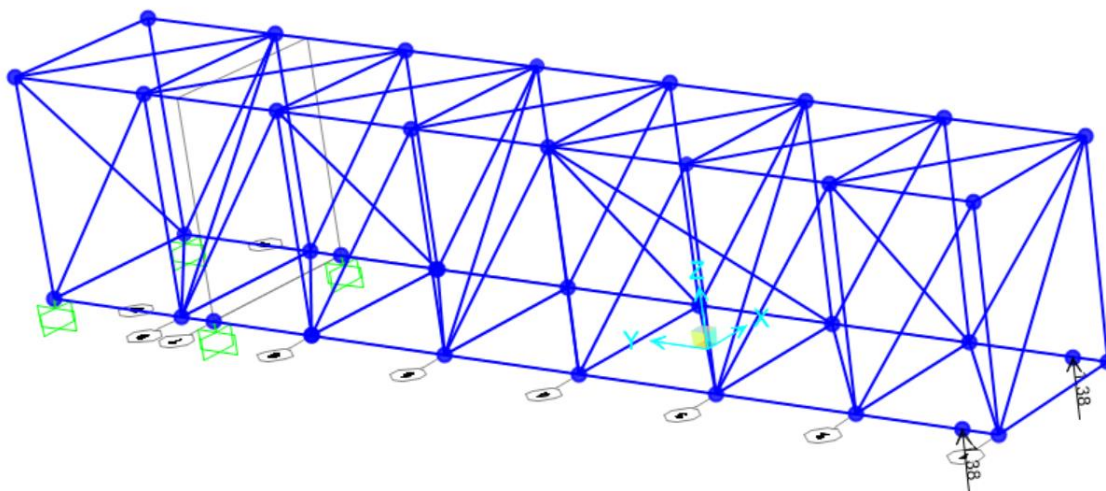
Cargas aplicadas en las extensiones de viga en toneladas
